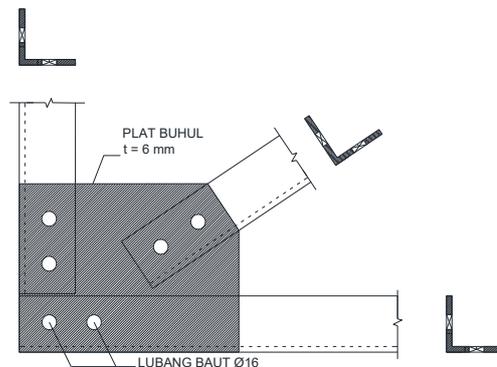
Tampak Samping Dan Denah Detail Sambungan
